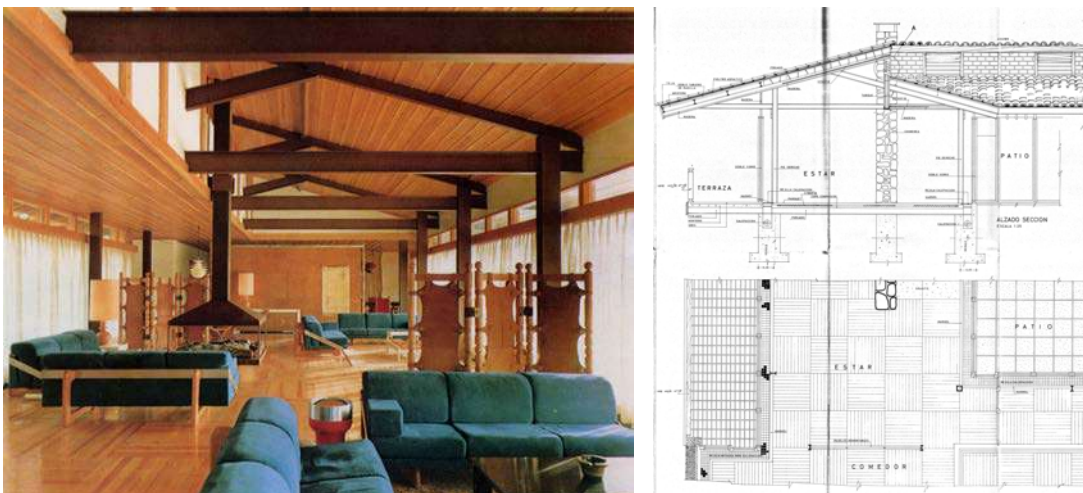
(a) Sala de estar. (b) Detalle constructivo.
